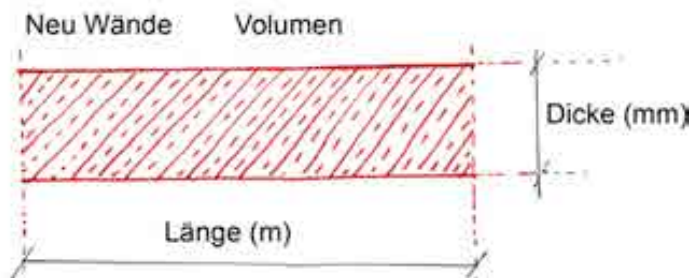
Vertikale Elemente , Gründung Neu Beton Wand
